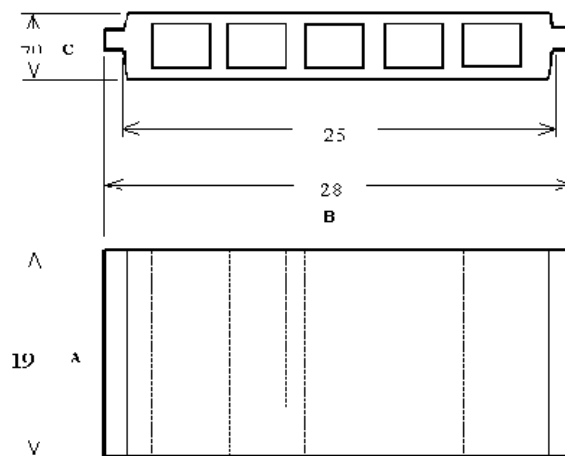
Desenho do Tijolo para Laje Pré-moldada 19 x 25 x 7
